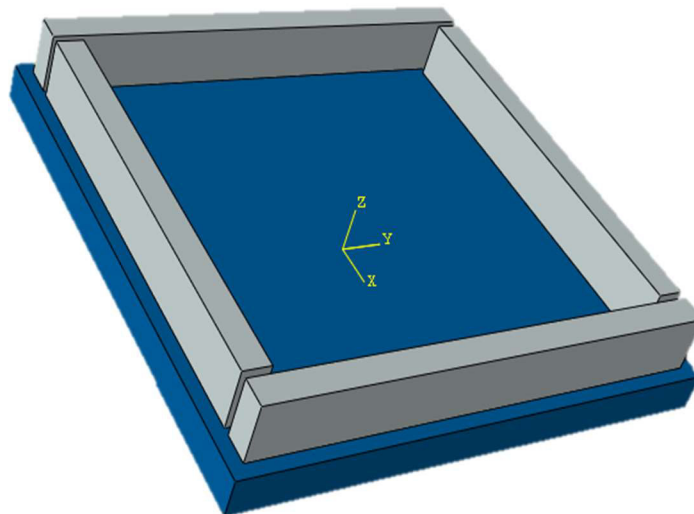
Vigas de reação nas lajes L1, L2 e L3.
